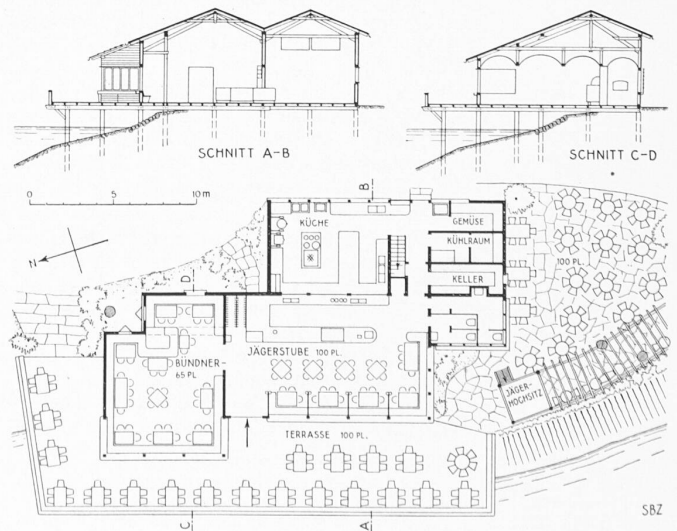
Grundriss und Schnitte der Bündner- und Jagdstube. 1:400
